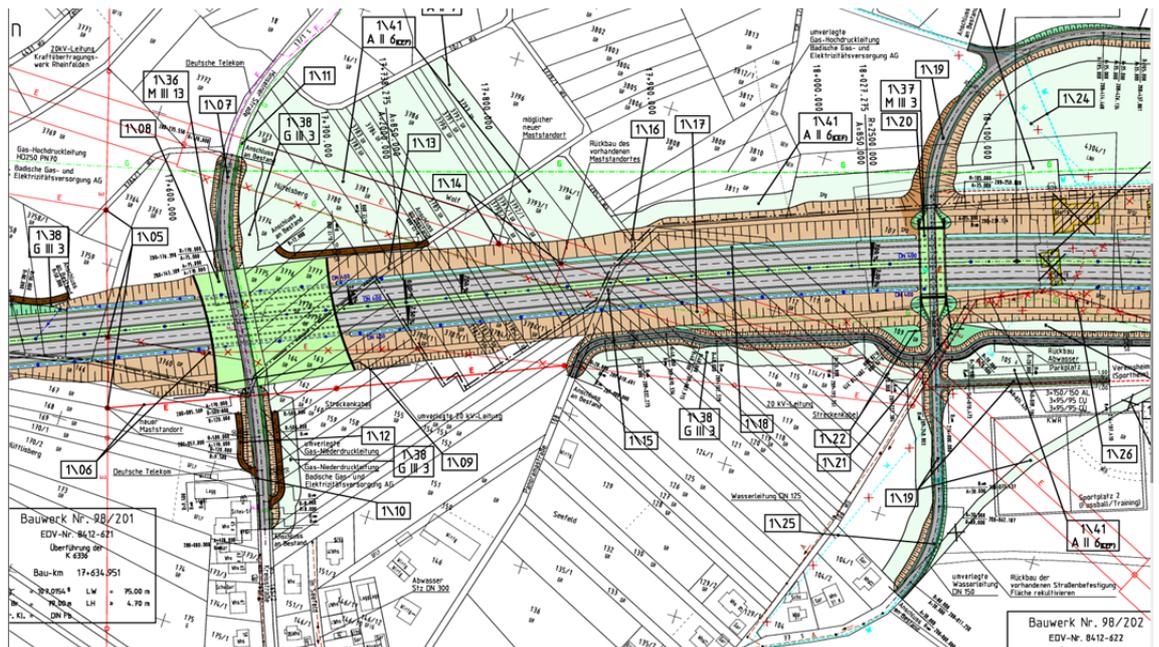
Ausschnitt als Lageplan Unterlage 5 Blatt 1
